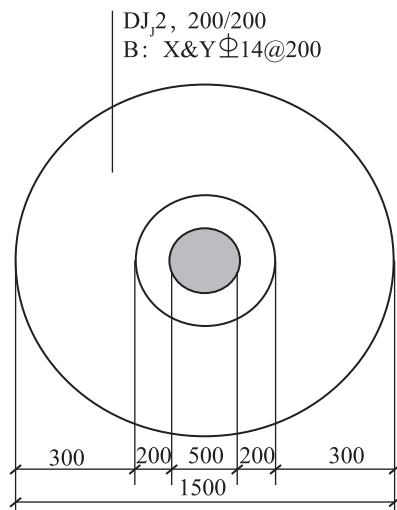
圆形独立基础双向正交配筋平面示意图 图 2-22 圆形独立基础双向正交钢筋示意图
